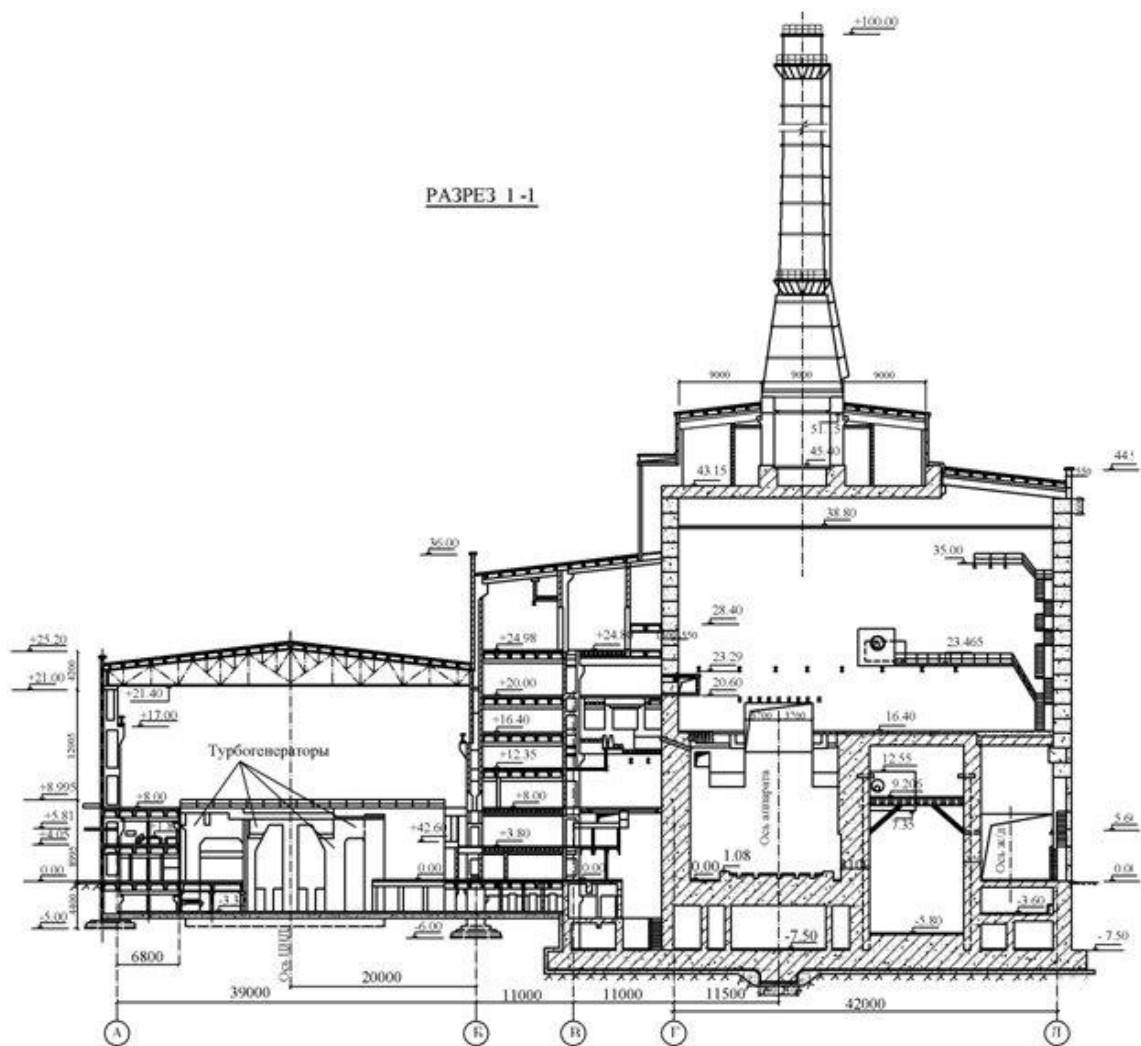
Разрез 1-1 главного корпуса первой очереди БЕЛАЭС. Выкопировка с листа №789646, Белоярская АЭС (Теплоэлектропроект, Ленинградское отделение 1963г.).
